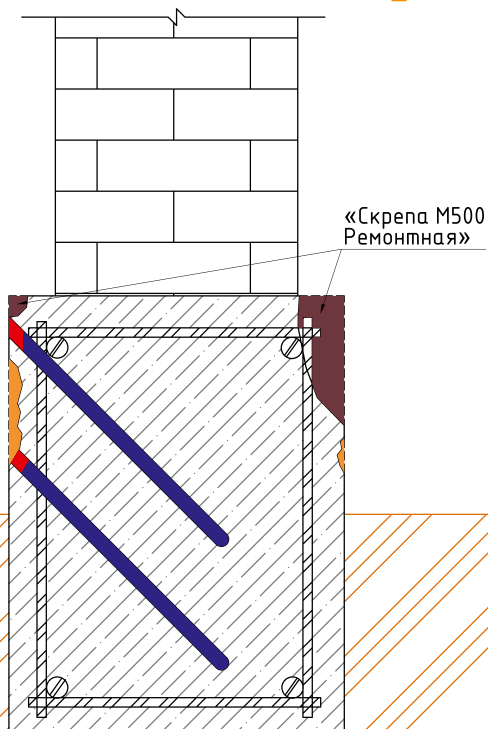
Схема ремонта незначительных дефектов бетона
